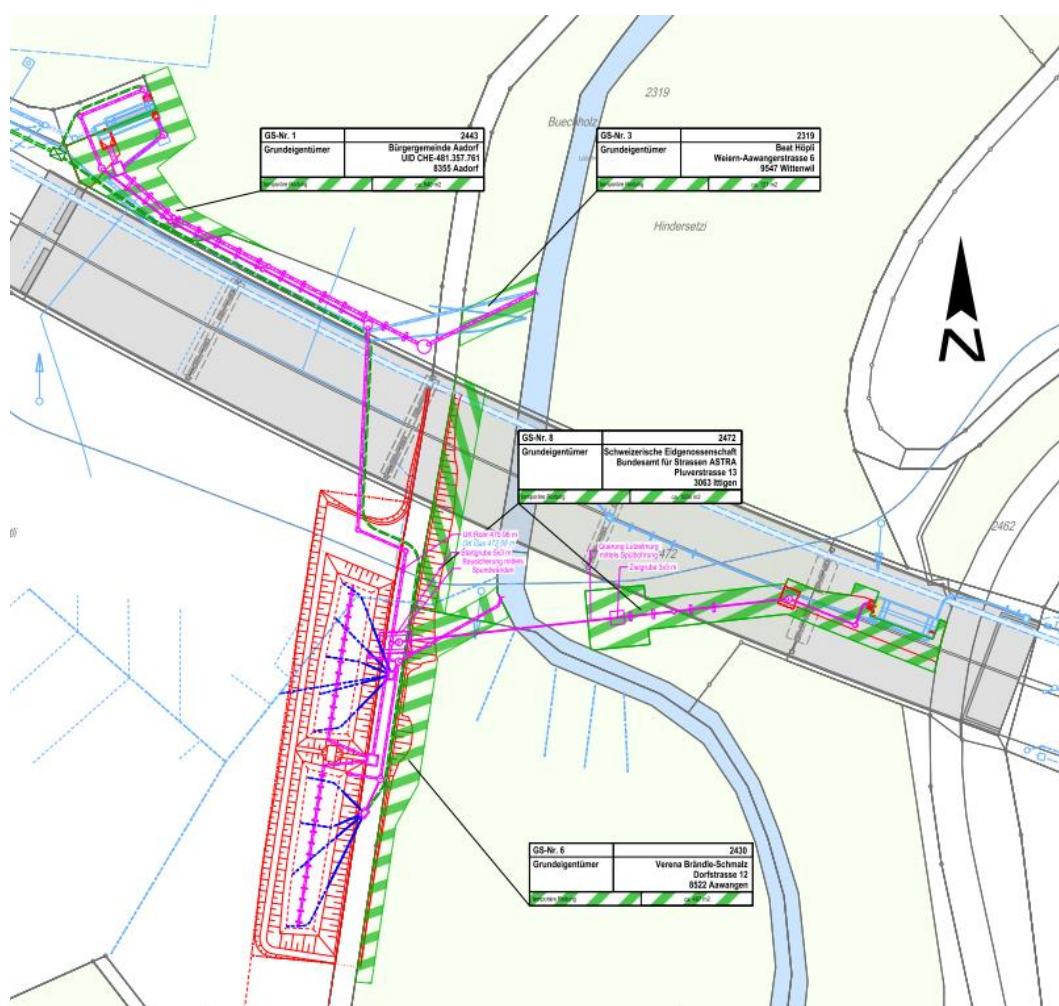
Ausschnitt aus dem Rodungsplan mit den eingezeichneten, tangierten Waldflächen
